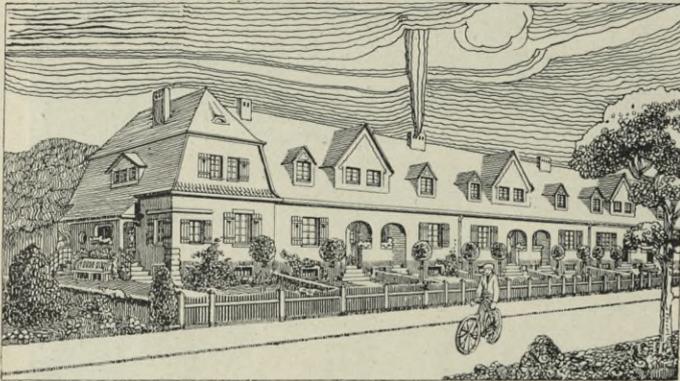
Reihenhaus für Saarbrücken. Architekt Kreisbaumeister Hender
